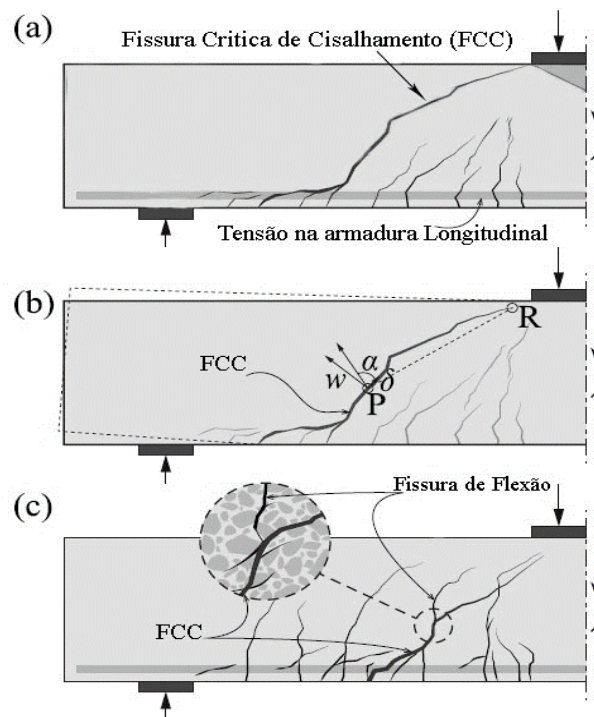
Padrão de fissuração e Cinemática da fissura em peças de concreto sem armadura transversal. Fonte: Adaptado de TIRASSA (2020)
